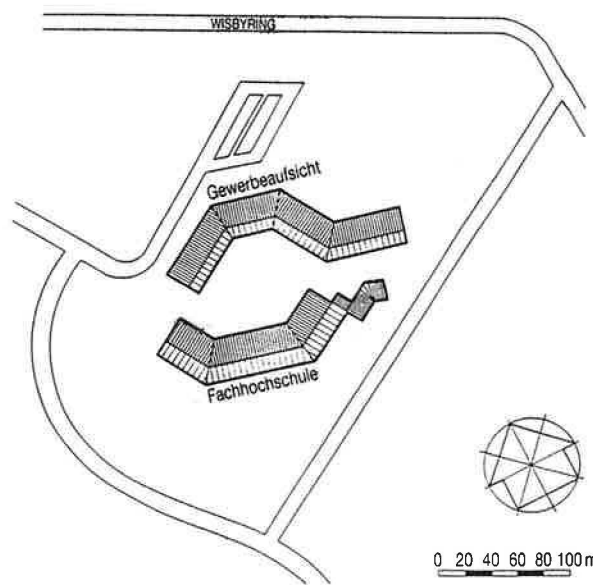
Lageplan für den Neubau des Gewerbeaufsichtsamtes in Soest.
